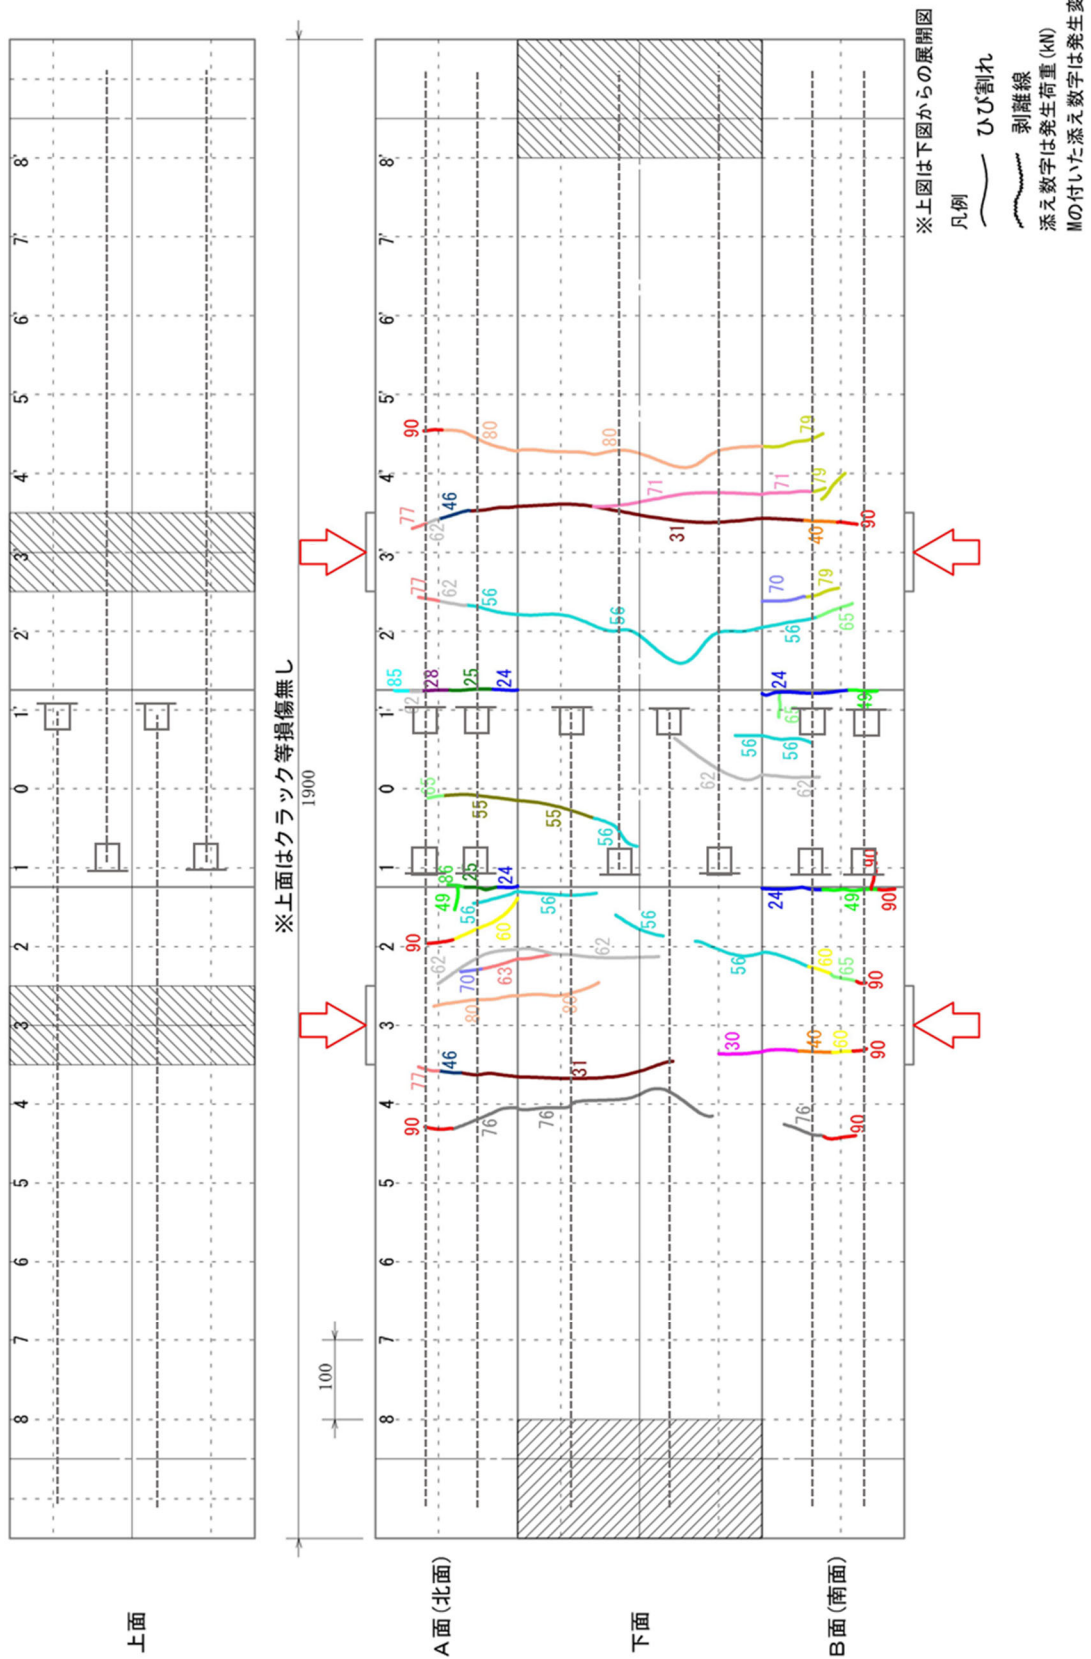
ひび割れ図 (供試体 S1-2)
